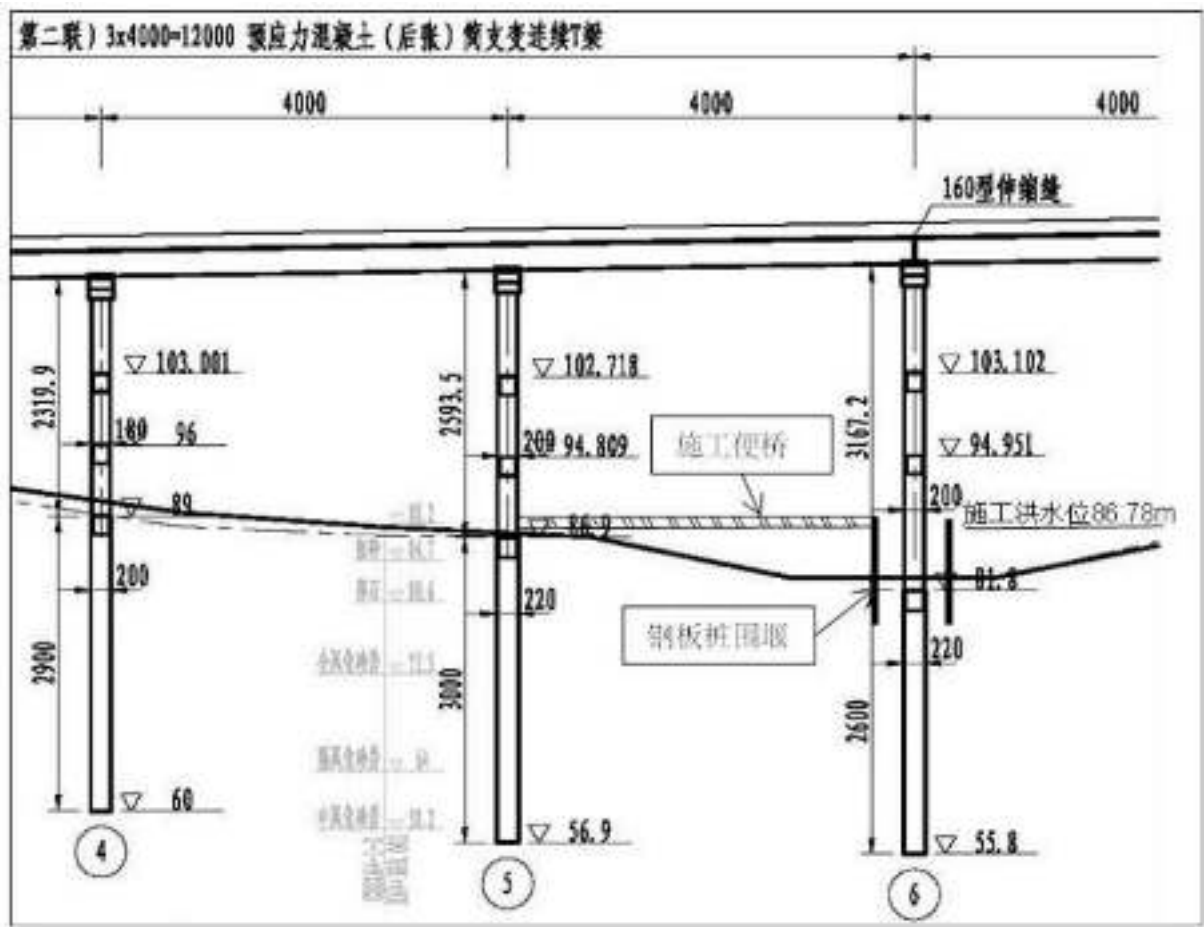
思务泗罗江大桥 6#桥墩钢板桩围堰施工剖面图
